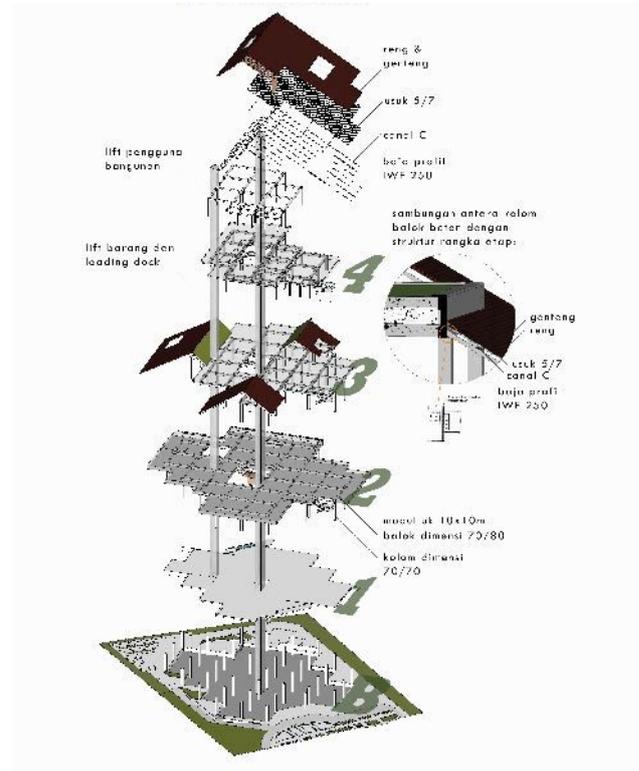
Detail pemasangan green roof dengan struktur baja.
